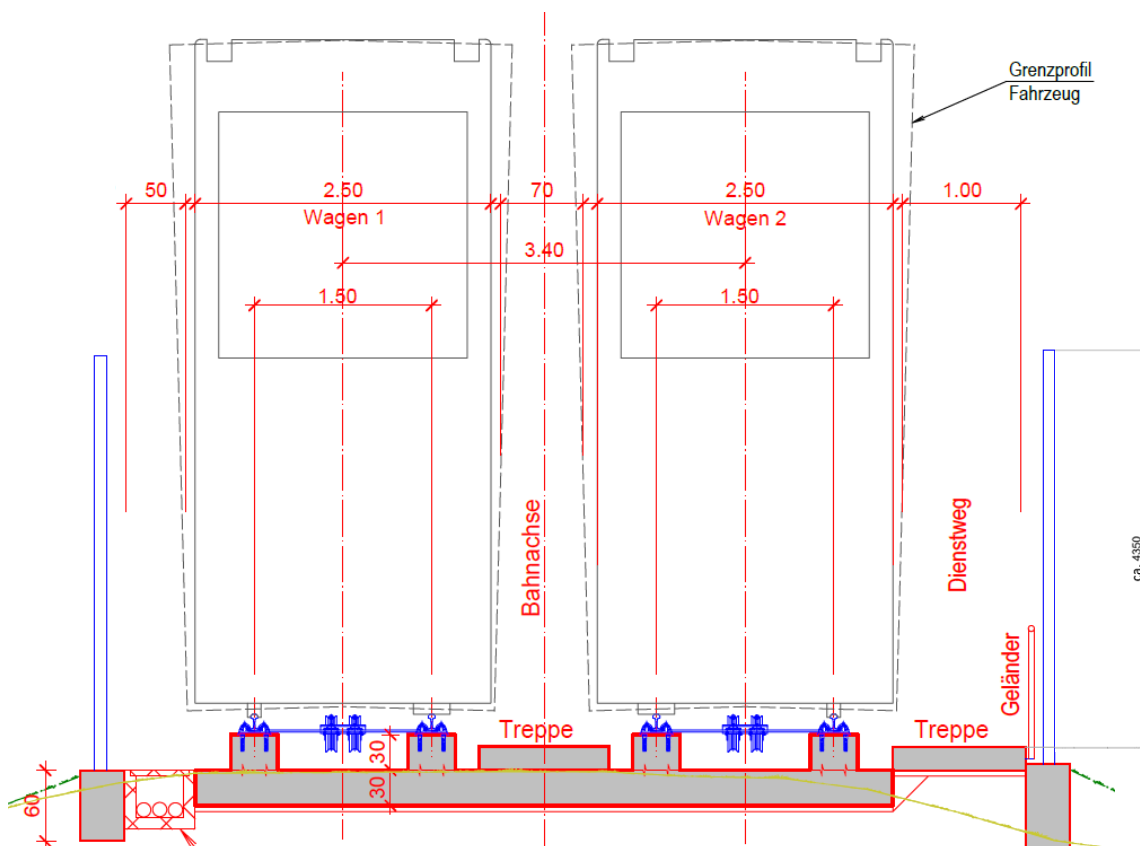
Baumfalleitung im Bereich Ausweiche/Betonfahrbahn
